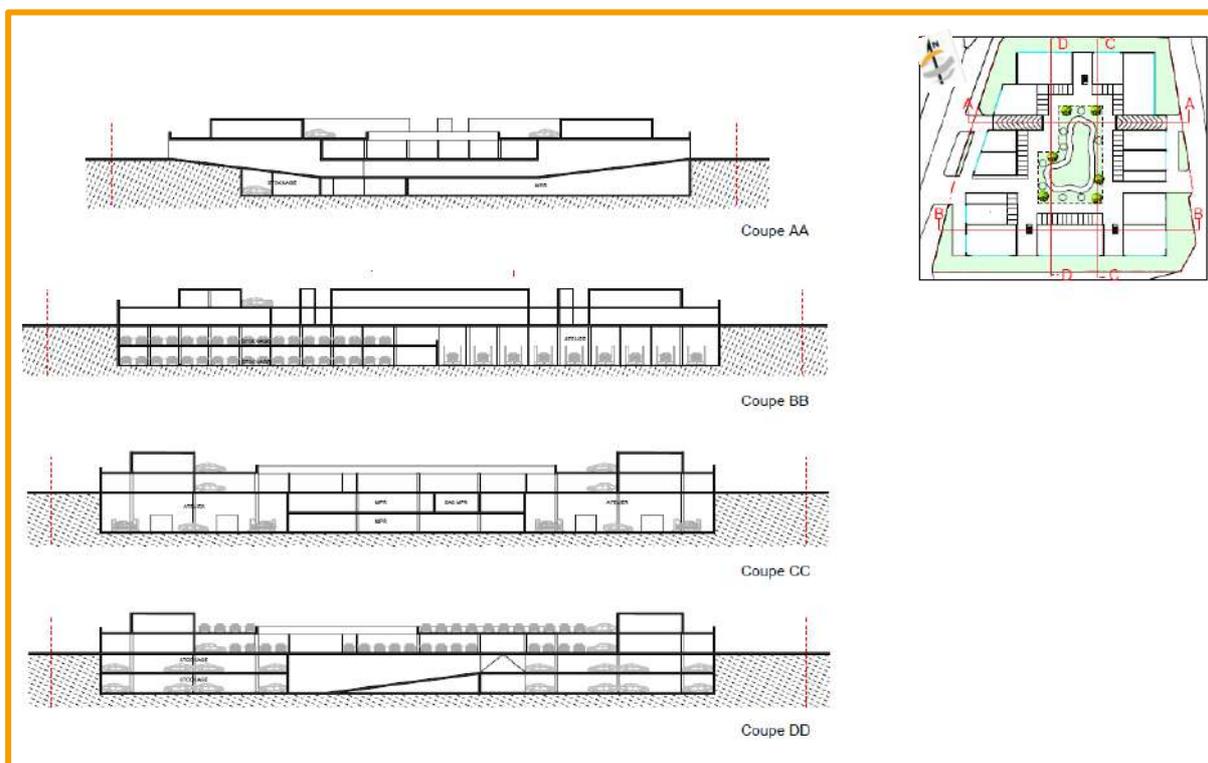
Plan de coupe du projet en date du 10/10/22 (source : Plan APS 03 réalisé par Archipel 41)
